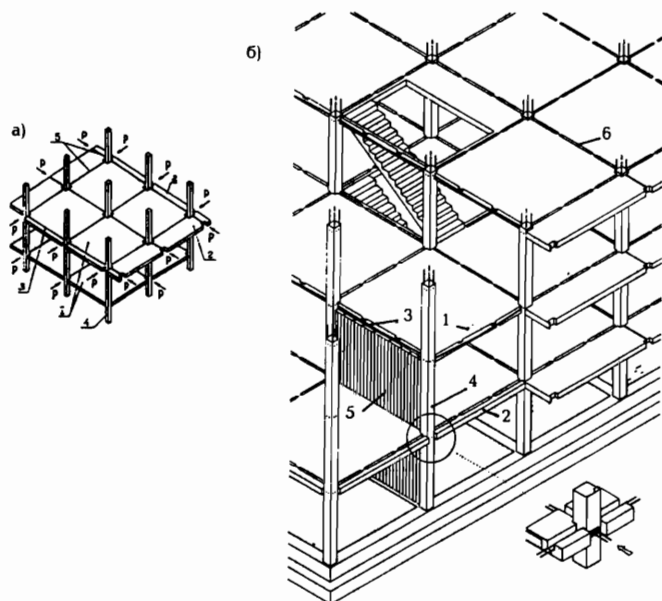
Каркасная система зданий с натяжением арматуры в построечных условиях: а – принципиальная схема; б – общий вид фрагмента здания; 1 – плита; 2 – бортовой элемент; 3 – преднапряженная арматура; 4 – колонны; 5 – внутренняя панель перегородки; 6 – монолитный участок; P – усилие натяжения
